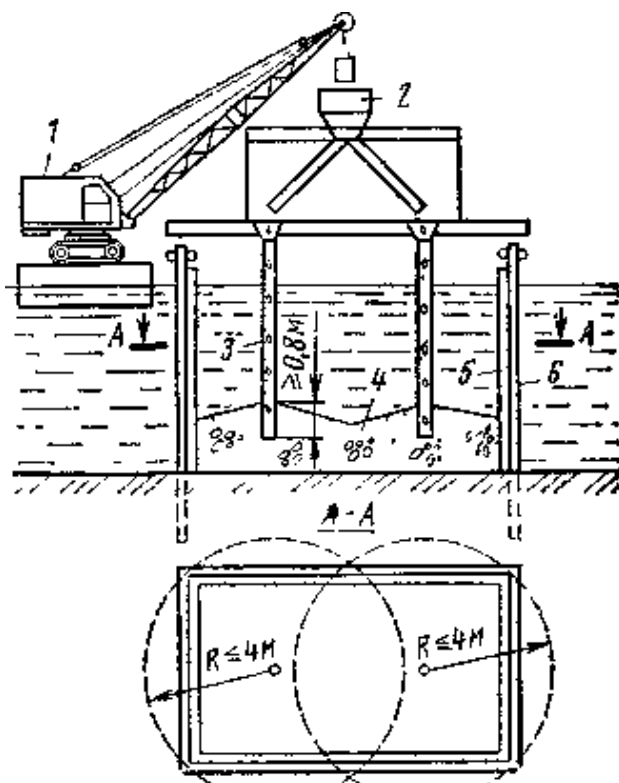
Схема подводного бетонирования способом ВПТ:
